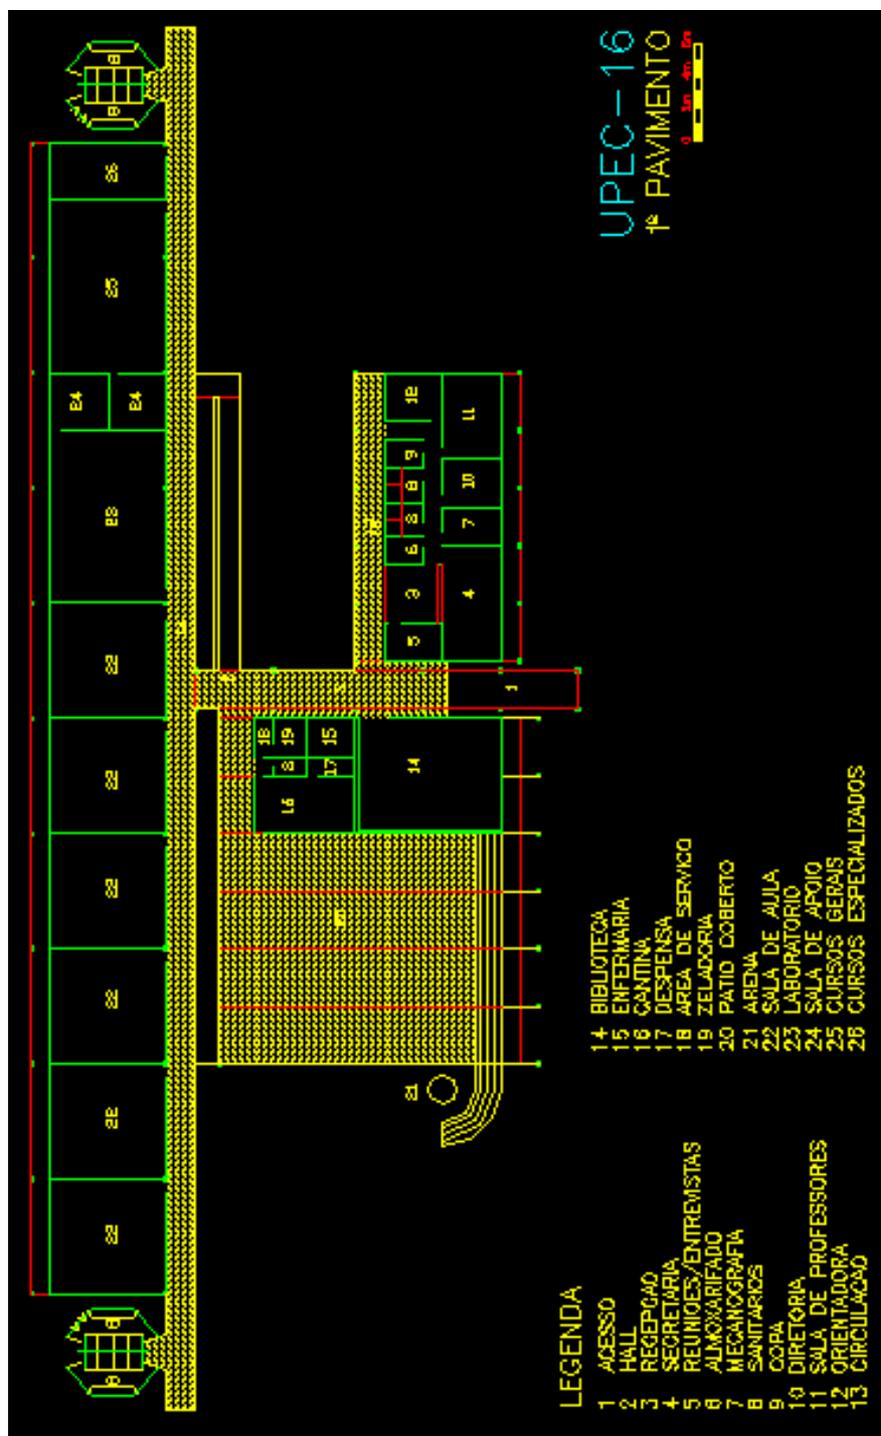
UPEC-16 / PLANTA 1º NÍVEL
